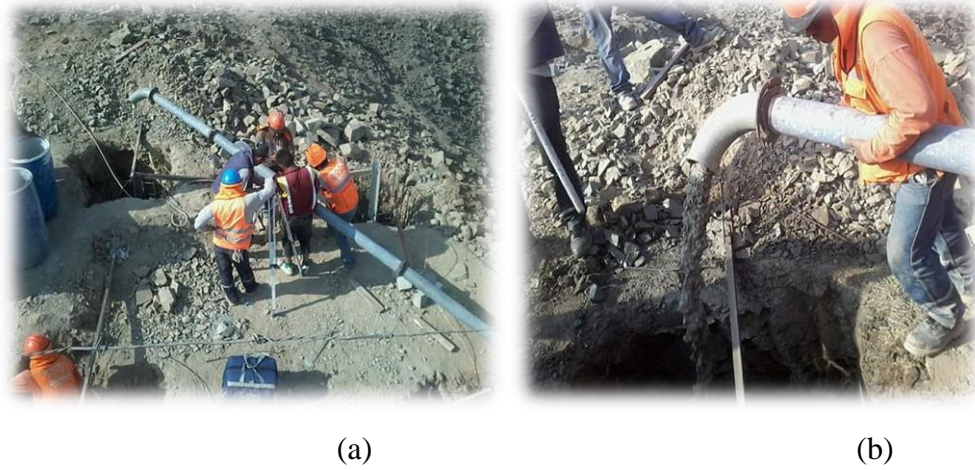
(a), (b).- Concreto para zapatas de torres.
